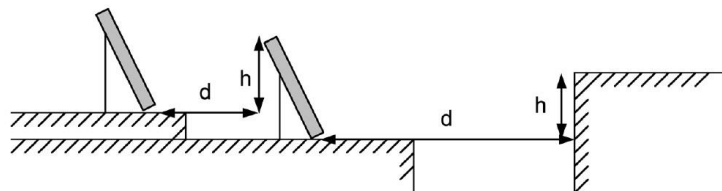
Separación entre fila de captadores y pretil de la cubierta
